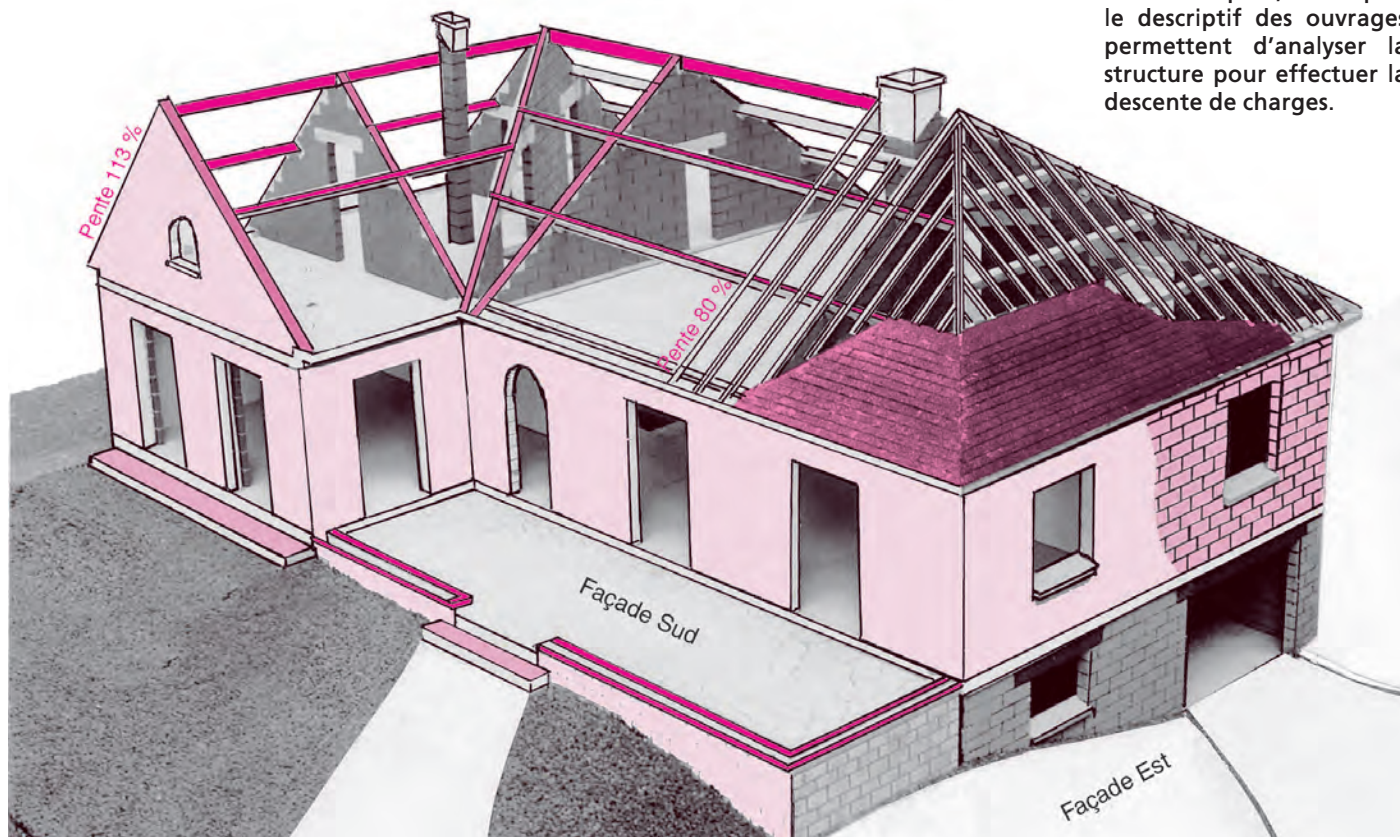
Maquette du pavillon avec sous-sol, rez-de-chaussée et combles aménageables
